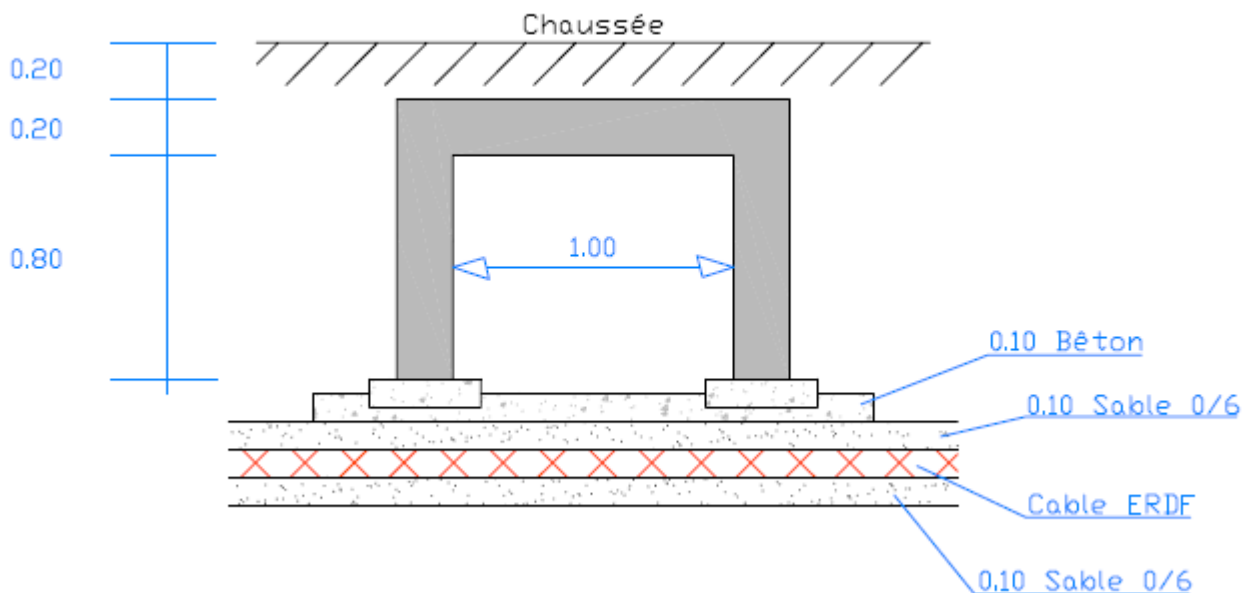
Exemple de coupe de principe d'une traversée disposée sous la RD14 à Geneuille (département du Doubs) – idéalement le substrat doit être terreux dans le fond de la traversée
